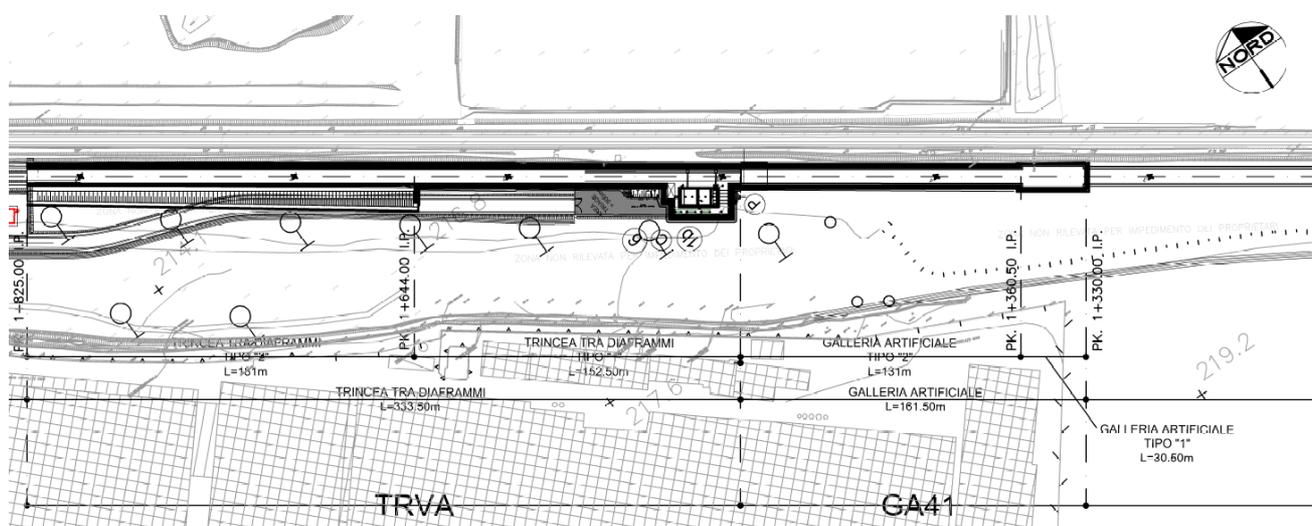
Stralcio planimetrico dell'opera in oggetto
